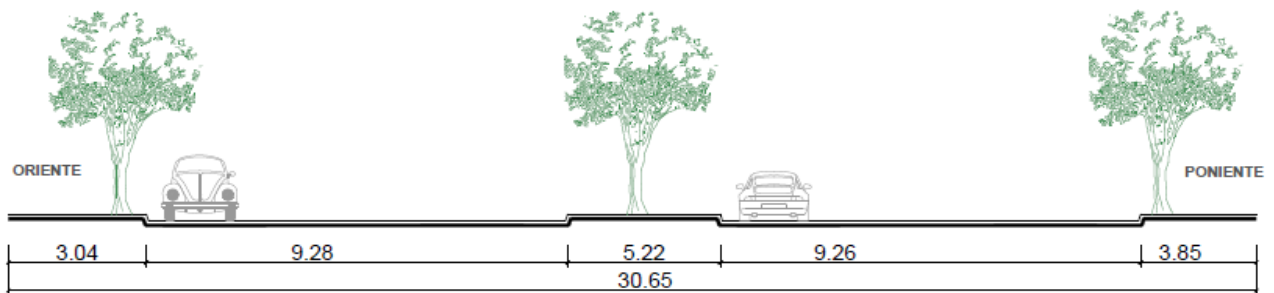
Sección Vial bulevar. Zacatecas cruce con bulevar Jiquilpan
